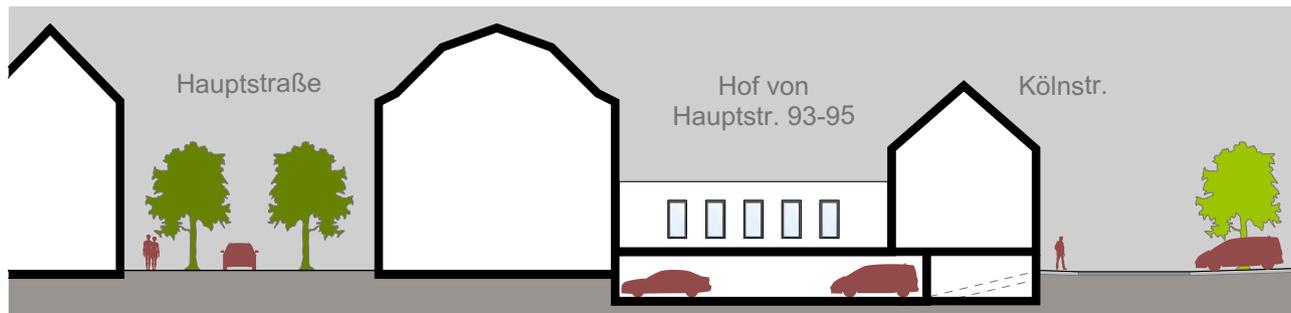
Schnitt Block 15 Hof Hauptstraße 93 - 95 M: 1:400
